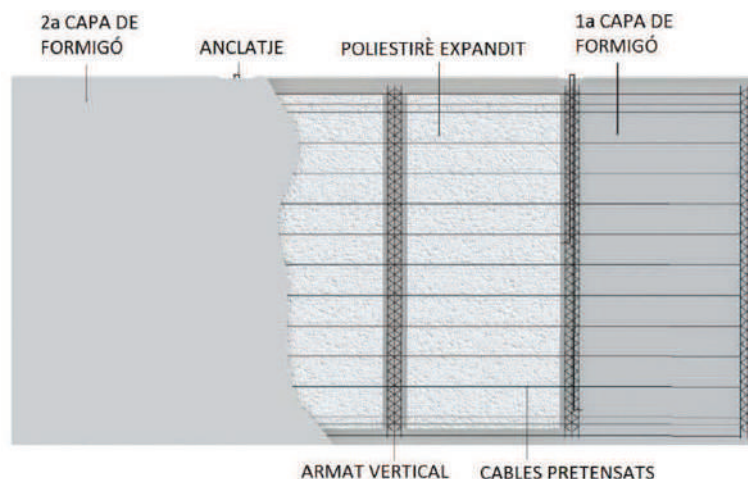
Esquema d'un panell prefabricat de formigó armat.
